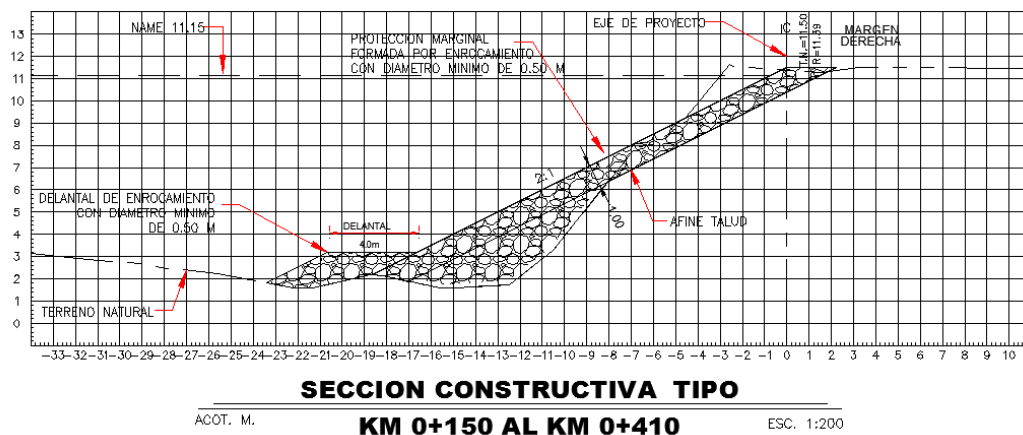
Sección constructiva Tipo, Protección Marginal
